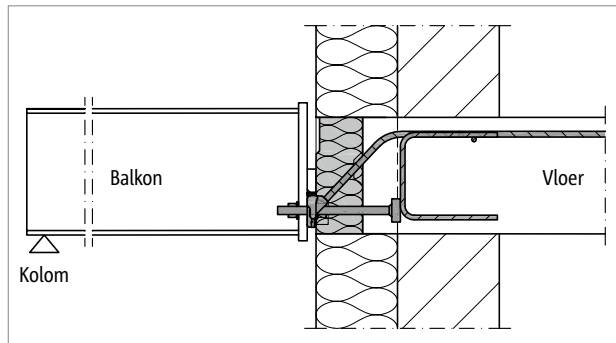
Schöck Isokorf® T type SQ-WU: Aangepaste korf; vereist voor aansluiting op een betonnen wand met een wanddikte vanaf 175 mm
